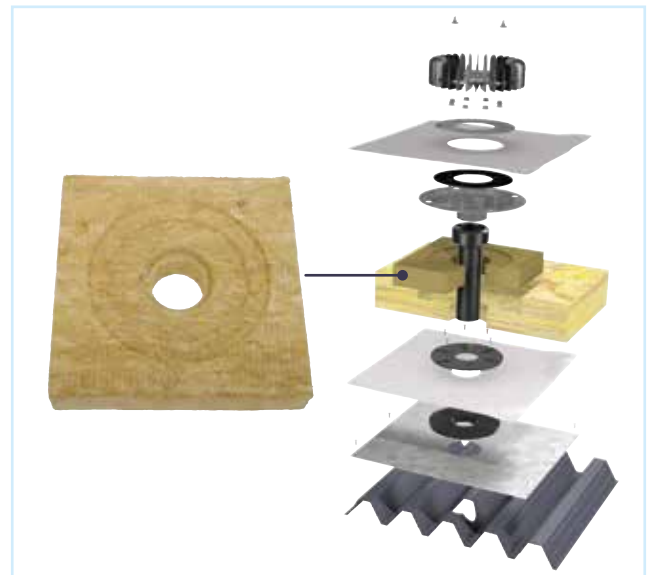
Construcción de una cubierta aislante con barrera de vapor.
